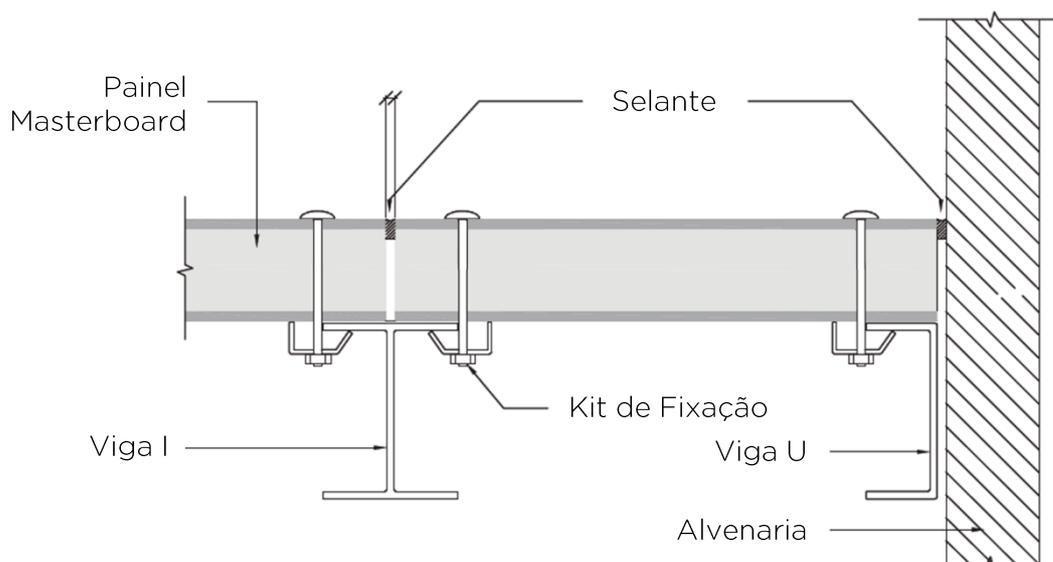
Detalhe de fixação do Painel Masterboard Brasilit sobre viga de aço pesado.
